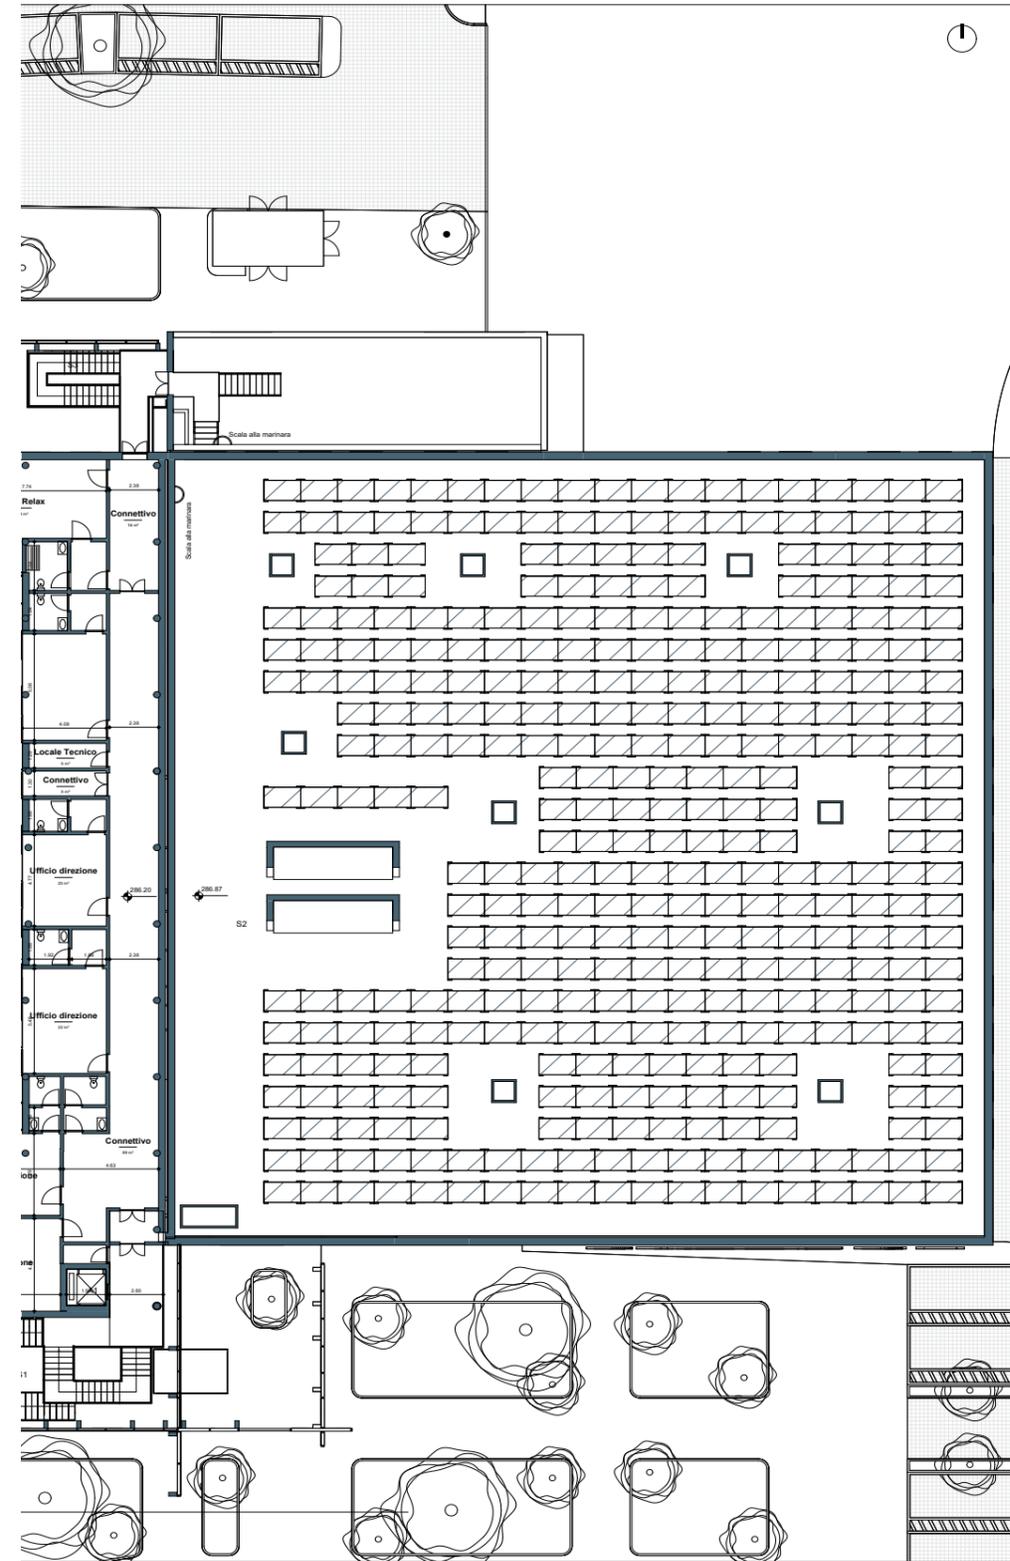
Pianta piano secondo (a cura di SMA Progetti)
